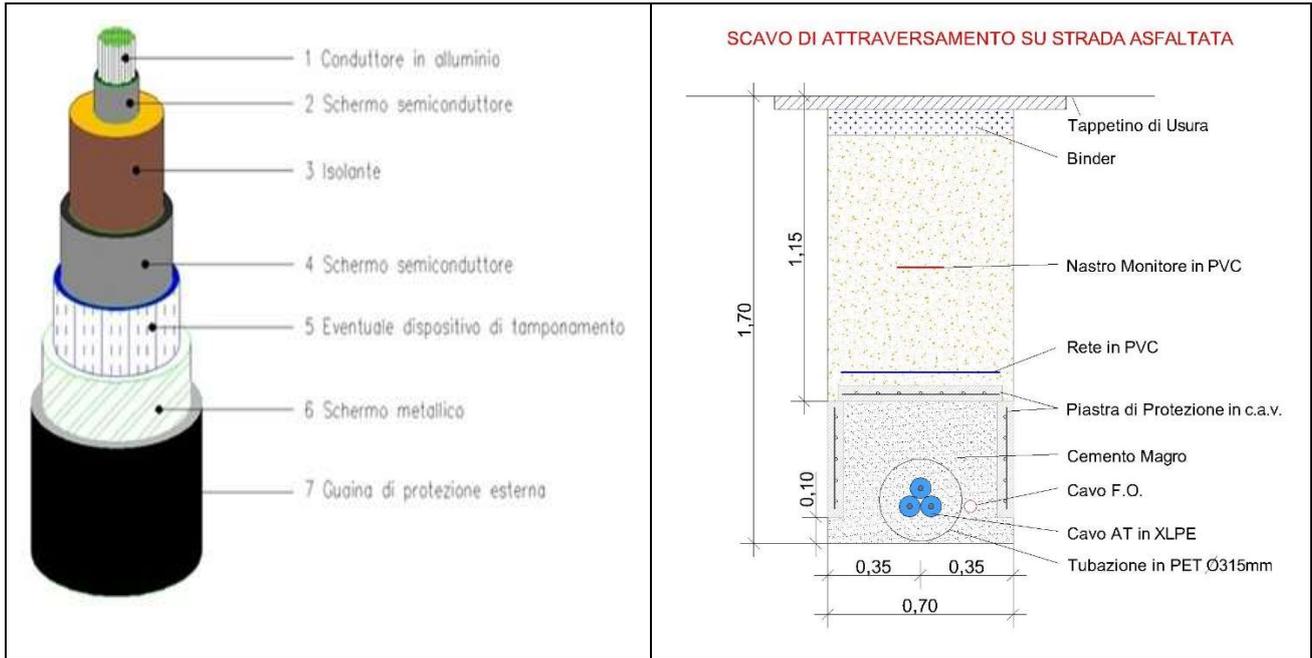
Sezione Cavo e Posa Cavo su Strada Asfaltata
